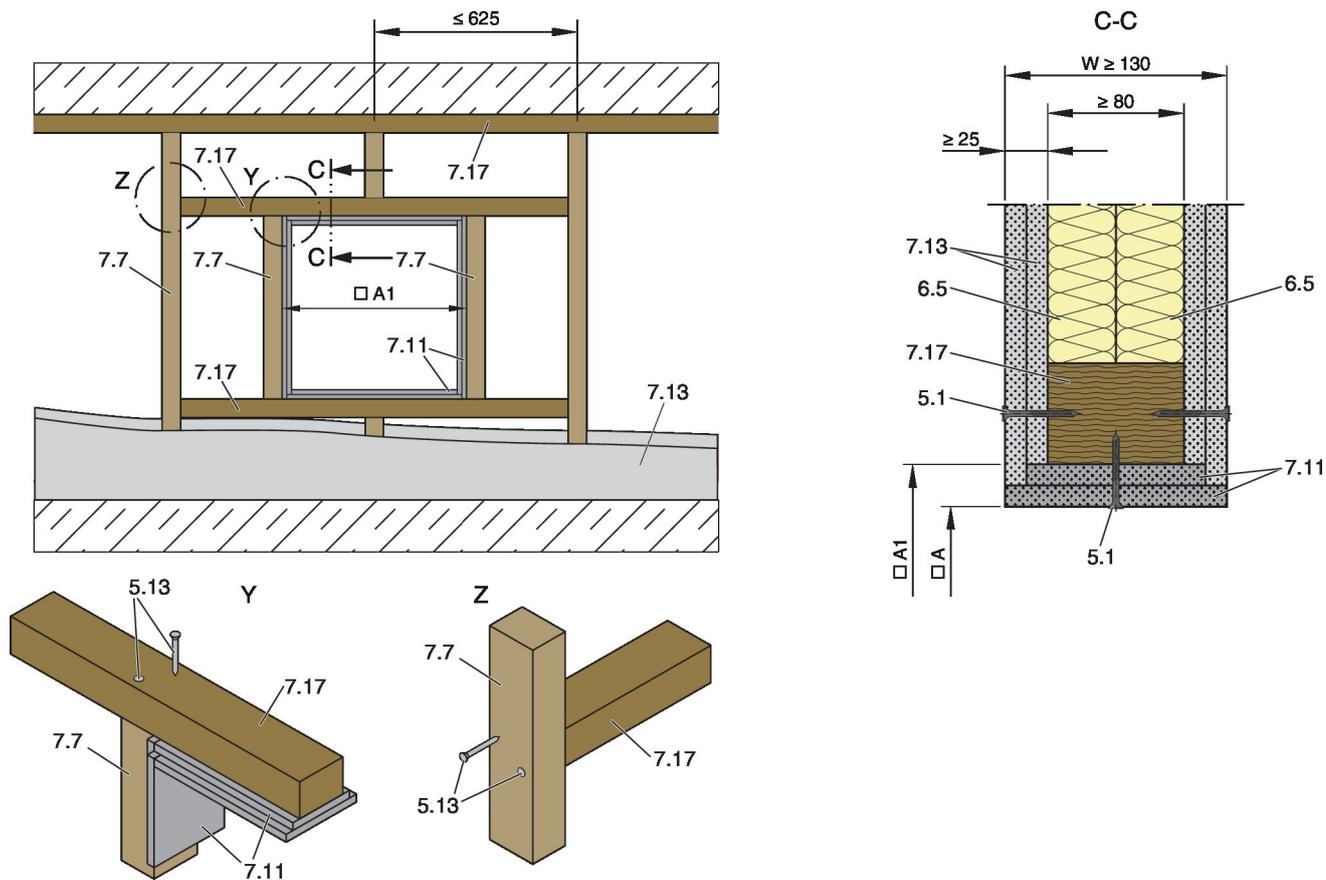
Leichtbauwand mit Holzständer und beidseitiger Beplankung
